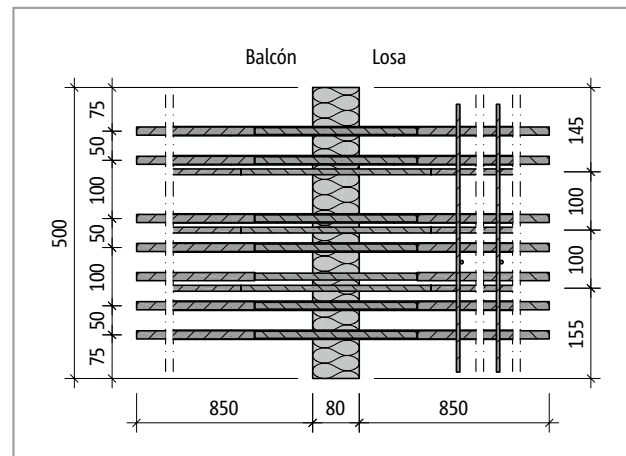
Schöck Isokorb® T tipo K-M13-V1: Plano del producto
